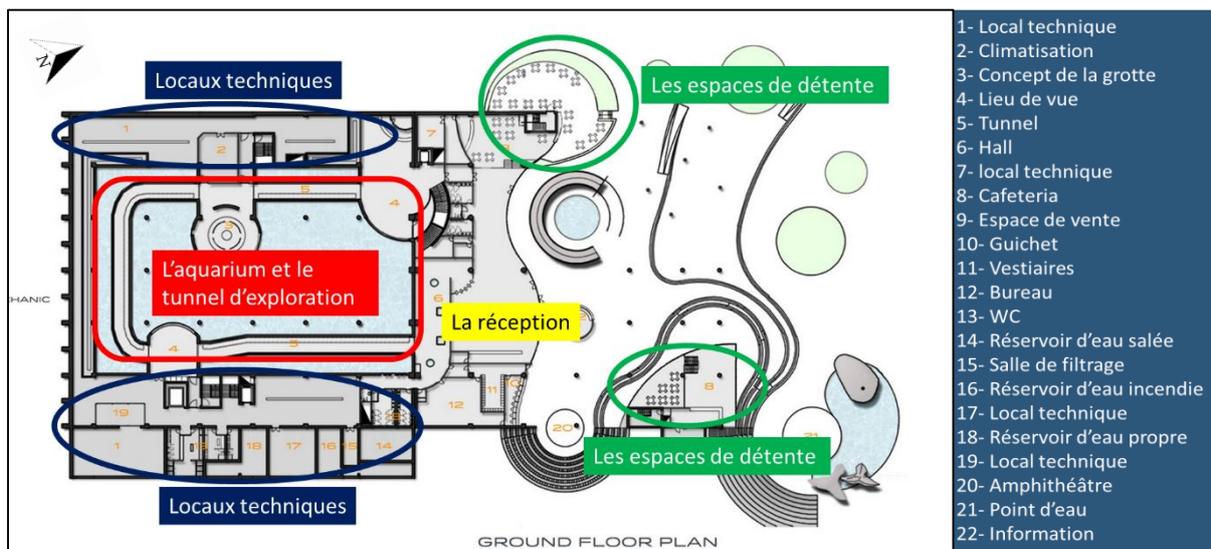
plan de rez-de-chaussée de l'aquarium
